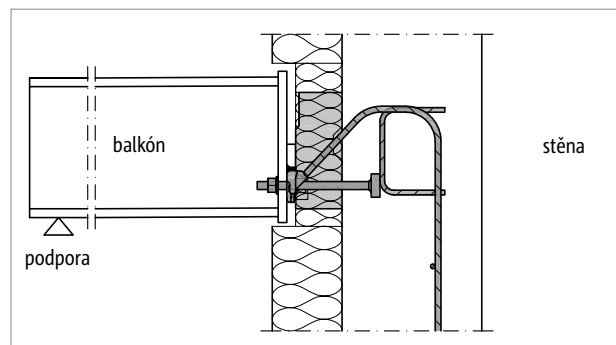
Schöck Isokorb® T typ SQP: Napojení na železobetonovou stropní desku; izolant uvnitř vnějšího zateplení
